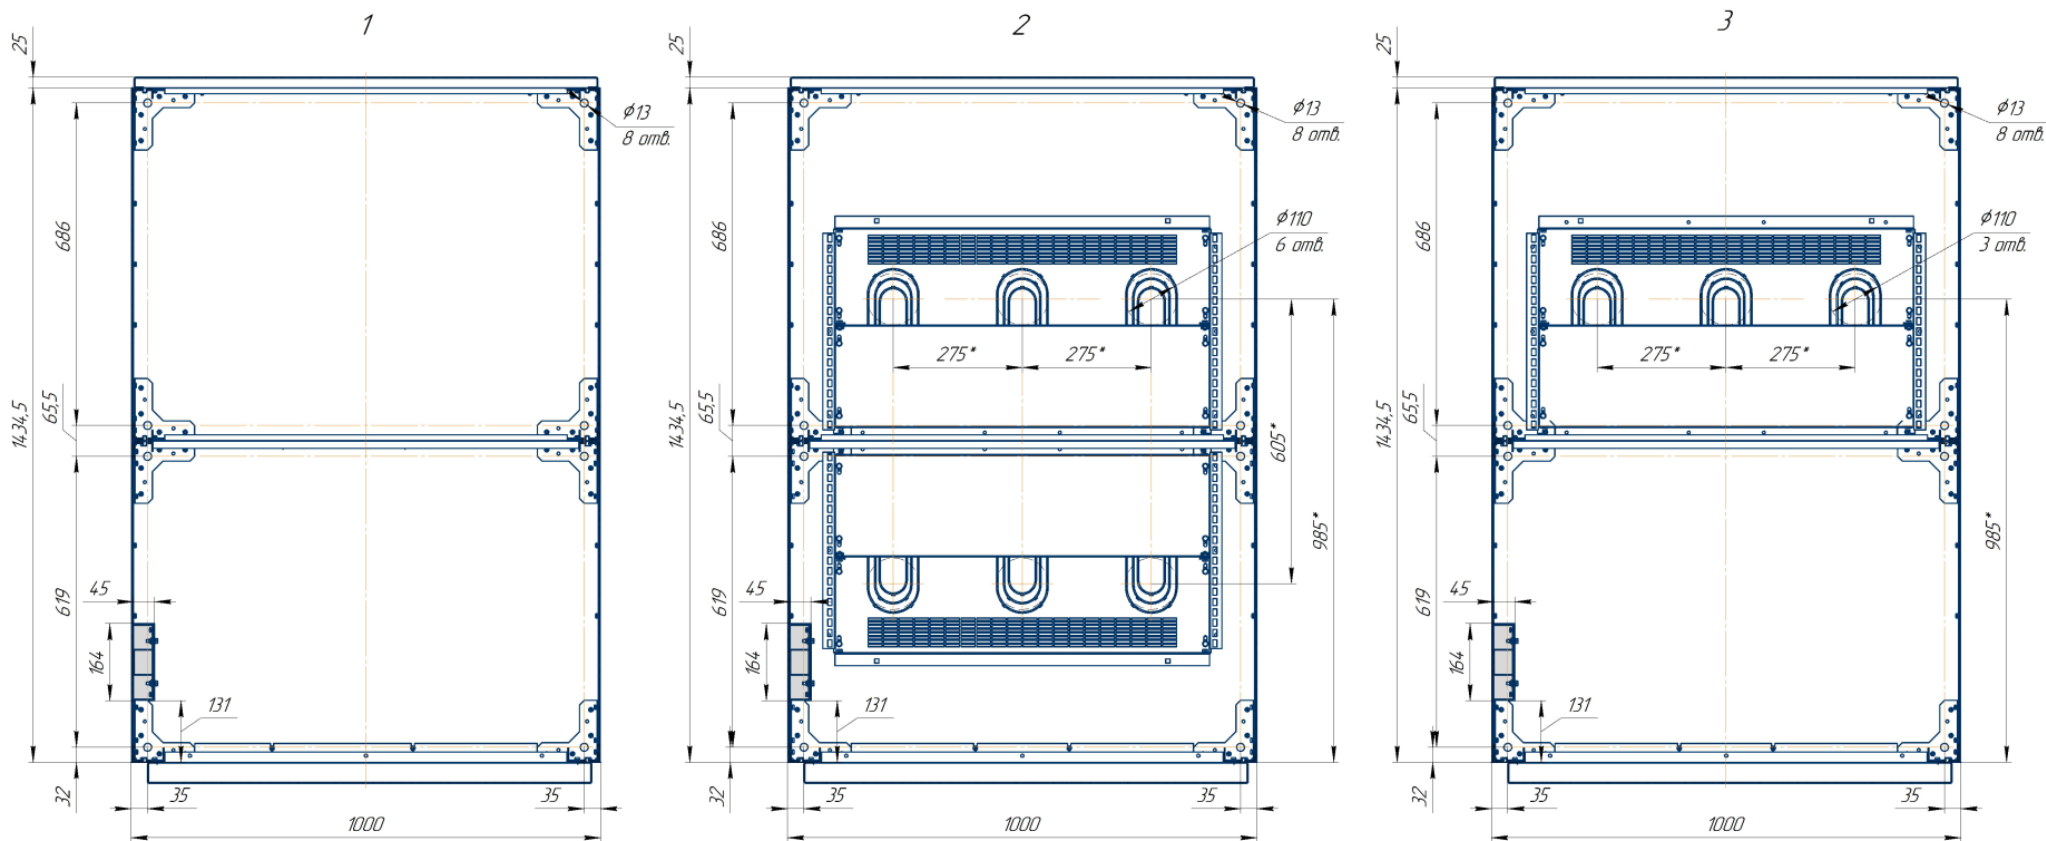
Установка КРУ-70-BLISS шириной 1000мм на фундамент
